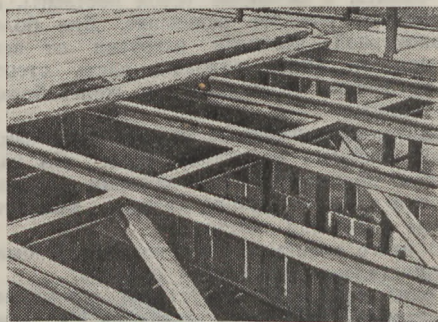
Пролетное строение моста из сварной рельсовой конструкции:
